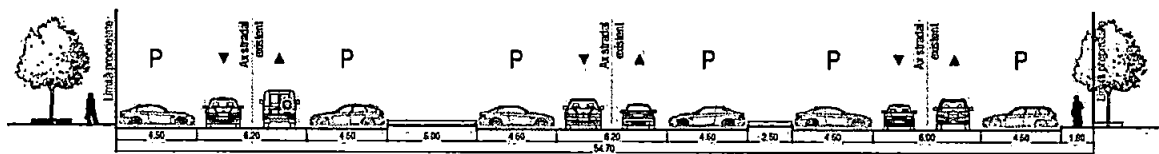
Profil stradal existent Aleea Daliei (efectuată transversal prin interiorul zonei reglementate).
